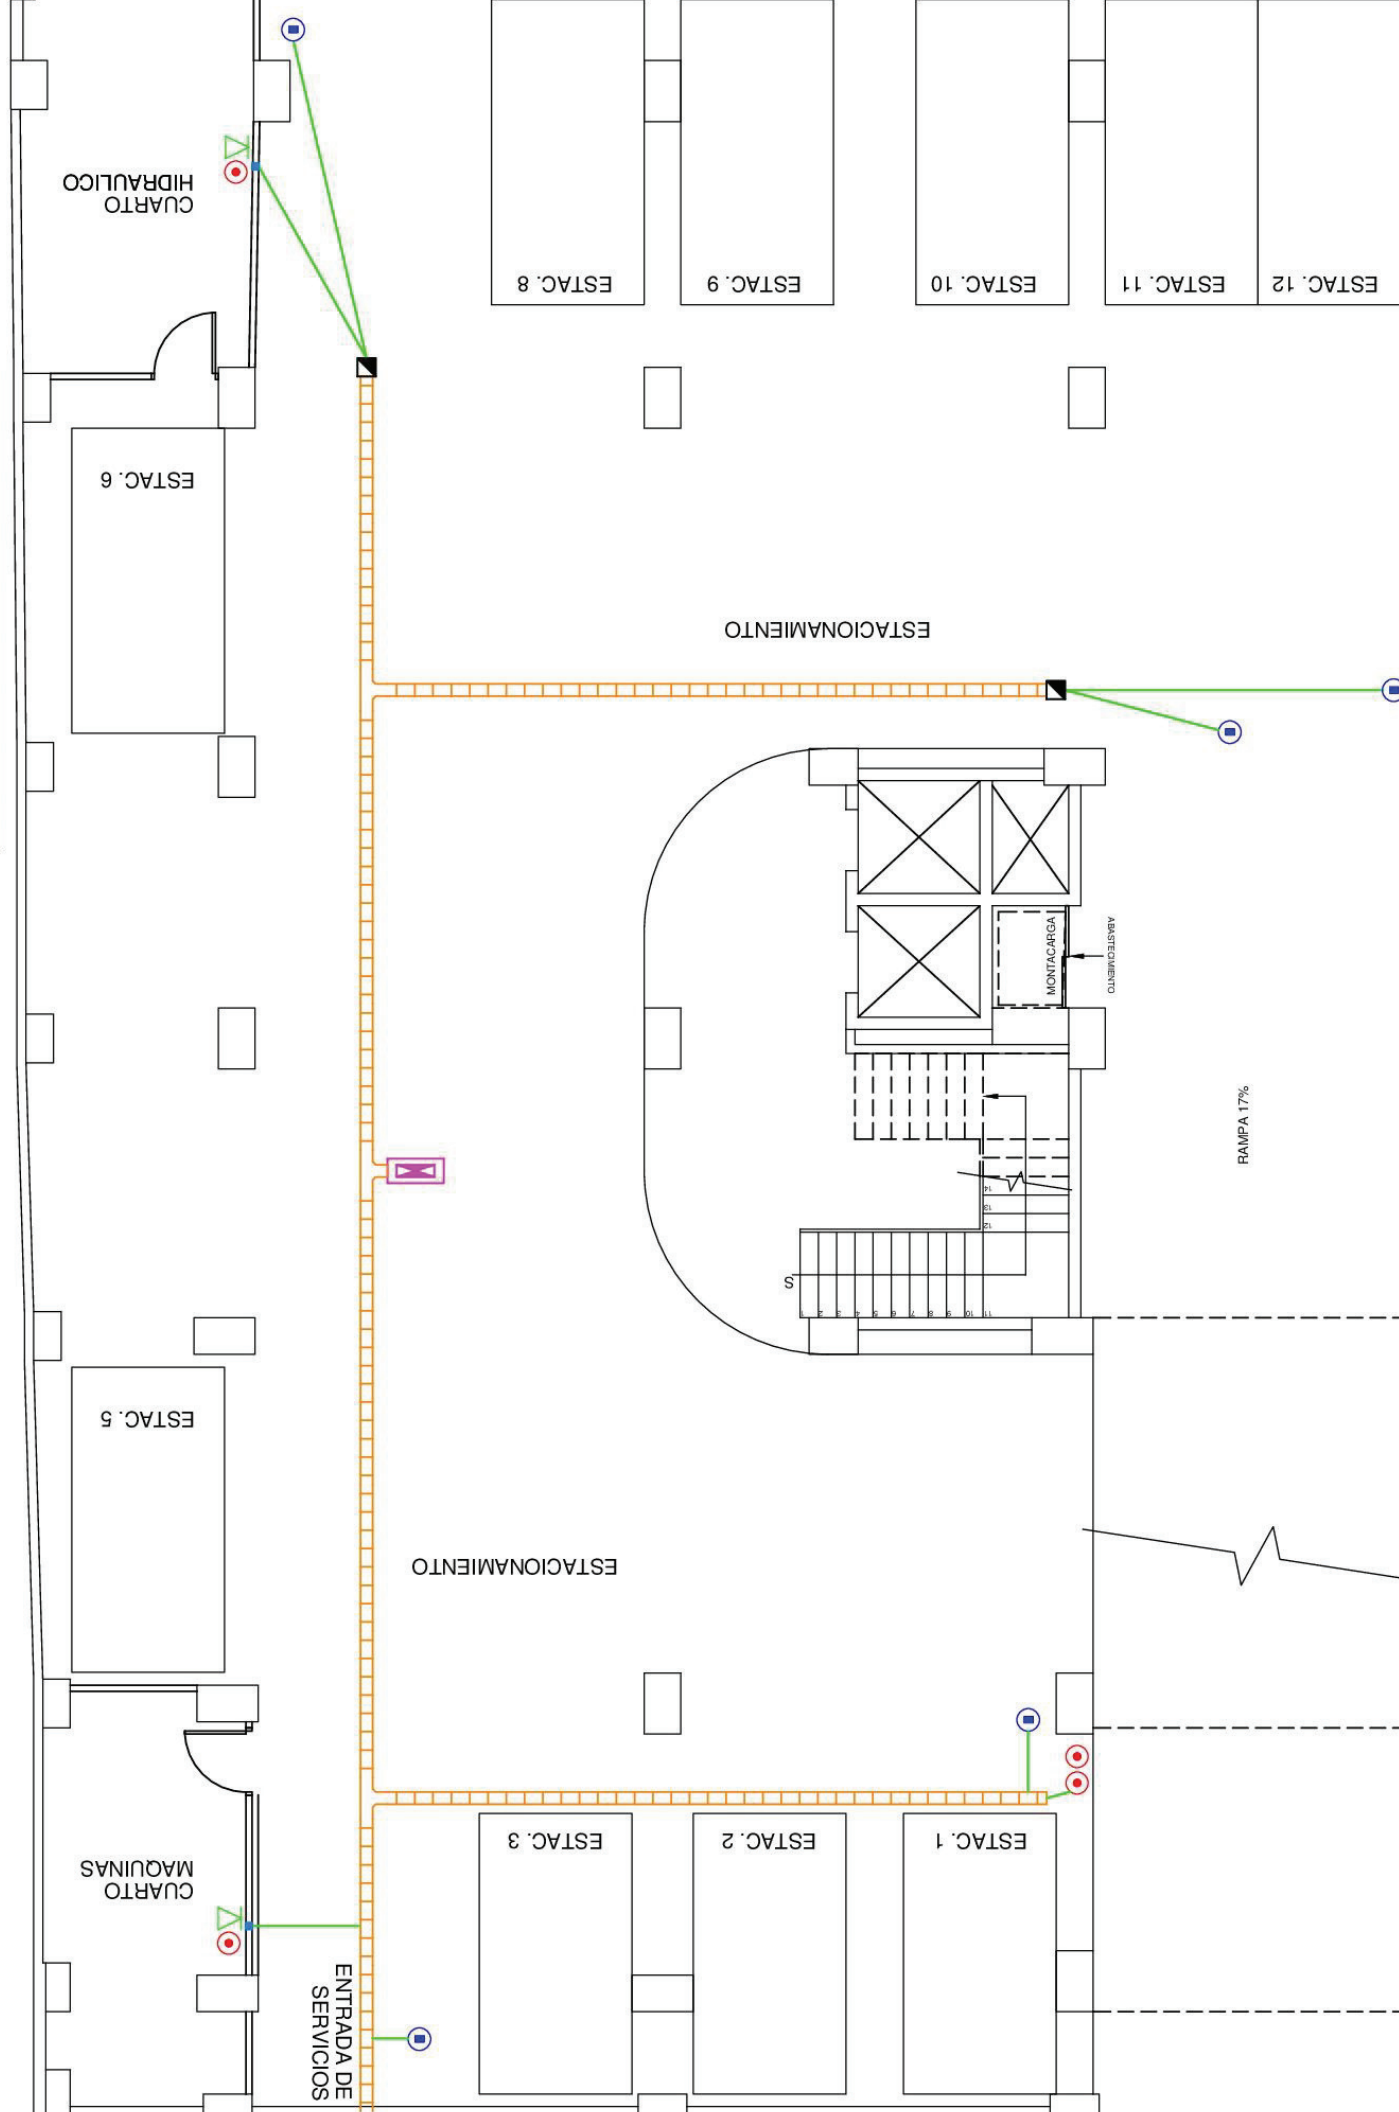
Detalle de tubería en el subsistema de cableado horizontal para datos y video.
